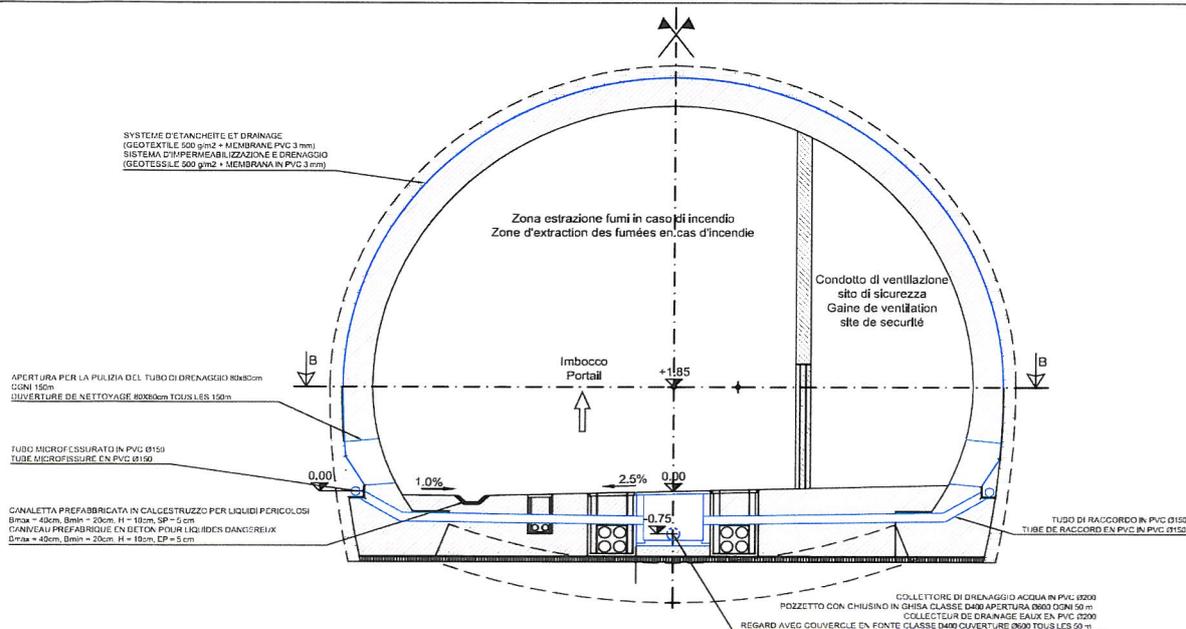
Sistema di drenaggio sulla sezione tipo corrente
